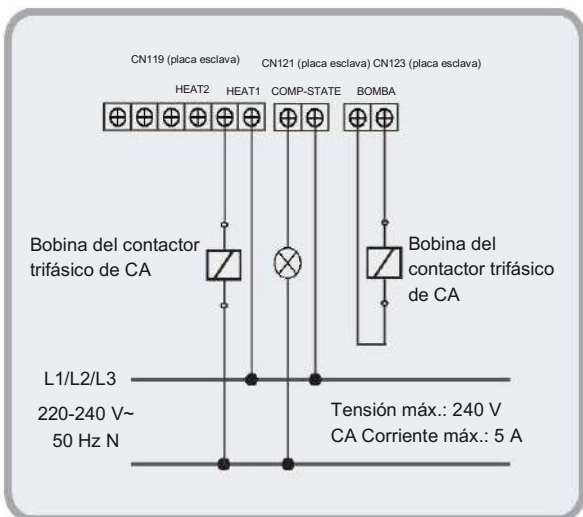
Cableado de la bomba de agua y del calentador auxiliar de tuberías y luz CA del estado del compresor
